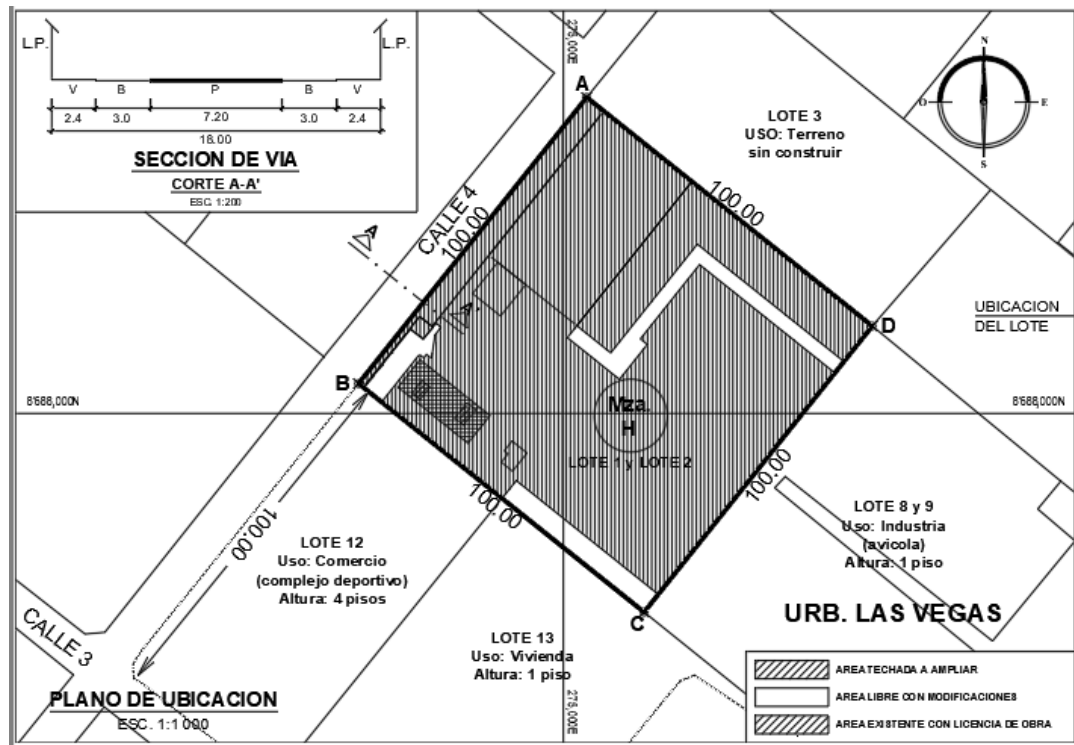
Plano de Ubicación del proyecto (anexo 03)
